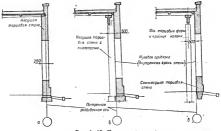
15. Привязка стен: a — торцовых несущих без пилястр; b — торцовых несущих с пилястрами; a — торцовых самонесущих.
